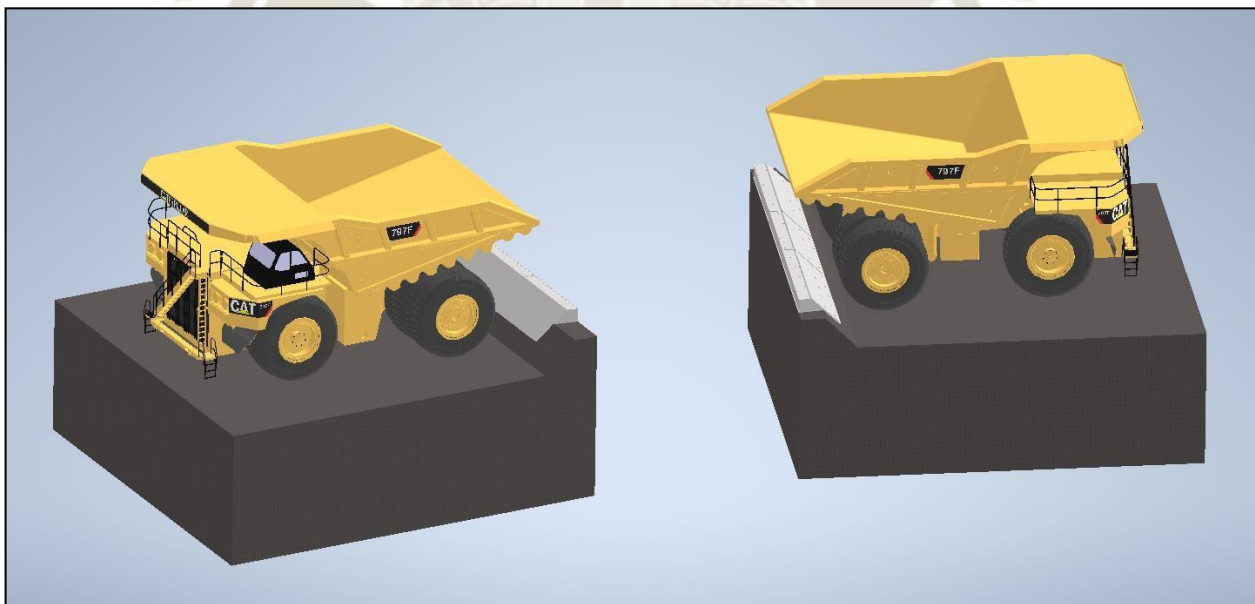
Modelado Extensión Metálica en campo. Fuente: Elaboración propia.
